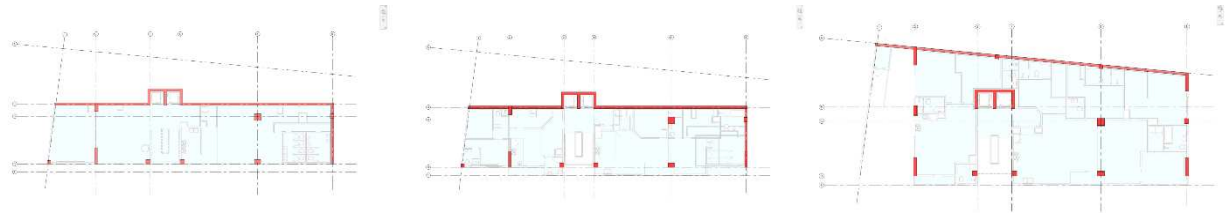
Columnas y Muros - Nivel 0, Nivel 1 y Nivel 3 - Fuente: Elaboración Propia
